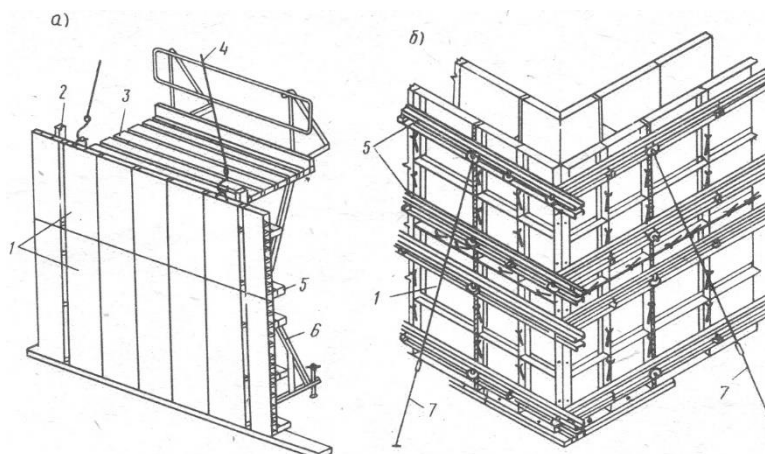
Формирование опалубочных панелей стен в мелкощитовой опалубке; а – опалубочная панель с рабочей площадкой и инвентарными подмостями; б – опалубка угла стены; 1 – щиты; 2 – вертикальная соединительная балка; 3 – рабочая площадка; 4 – строп; 5 – продольные схватки; 6 – инвентарный подкос; 7 – струбцина.
